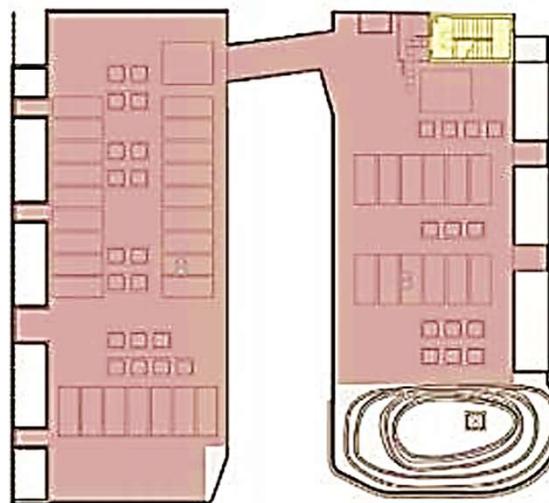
Planta de Cobertura La Brea | Autor: Patrick Tighe Architecture
